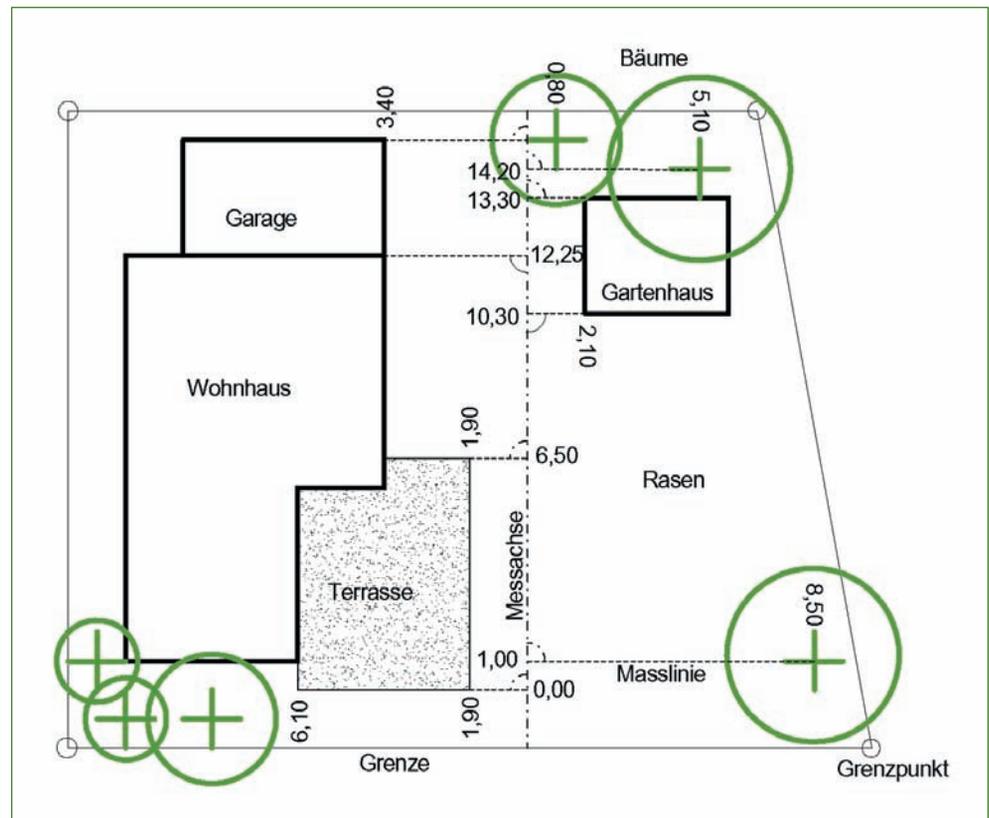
Plangrundlage als Beispiel, Aufnahme und Einzeichnen der Gartenelemente.
